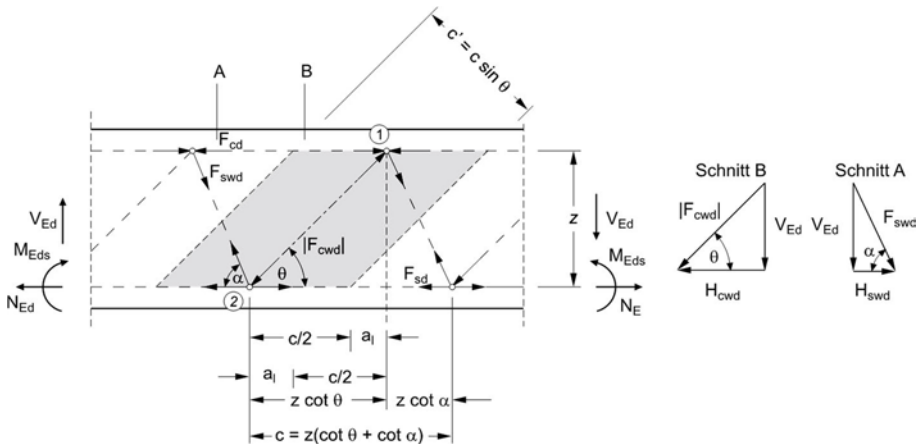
Strebenkräfte des einfachen Gelenkfachwerks (Zilch und Zehetmaier 2010)
